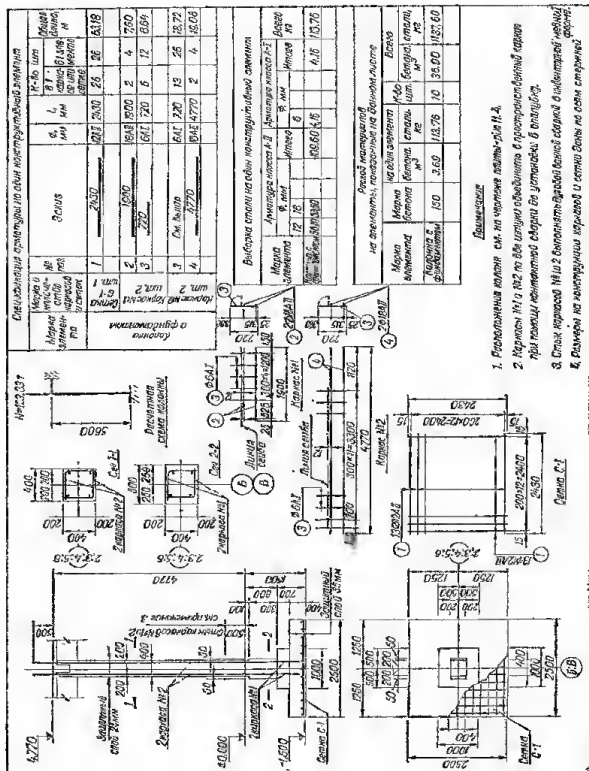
Армирование колонны и фундамента сварными каркасами и сетками.
